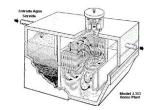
FUENTE: www.detallesconstructivos.net/cat egoria/claves/anclaje&docid
